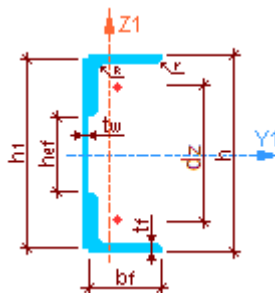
Схема профиля Швеллер сварной из листа и уголков
